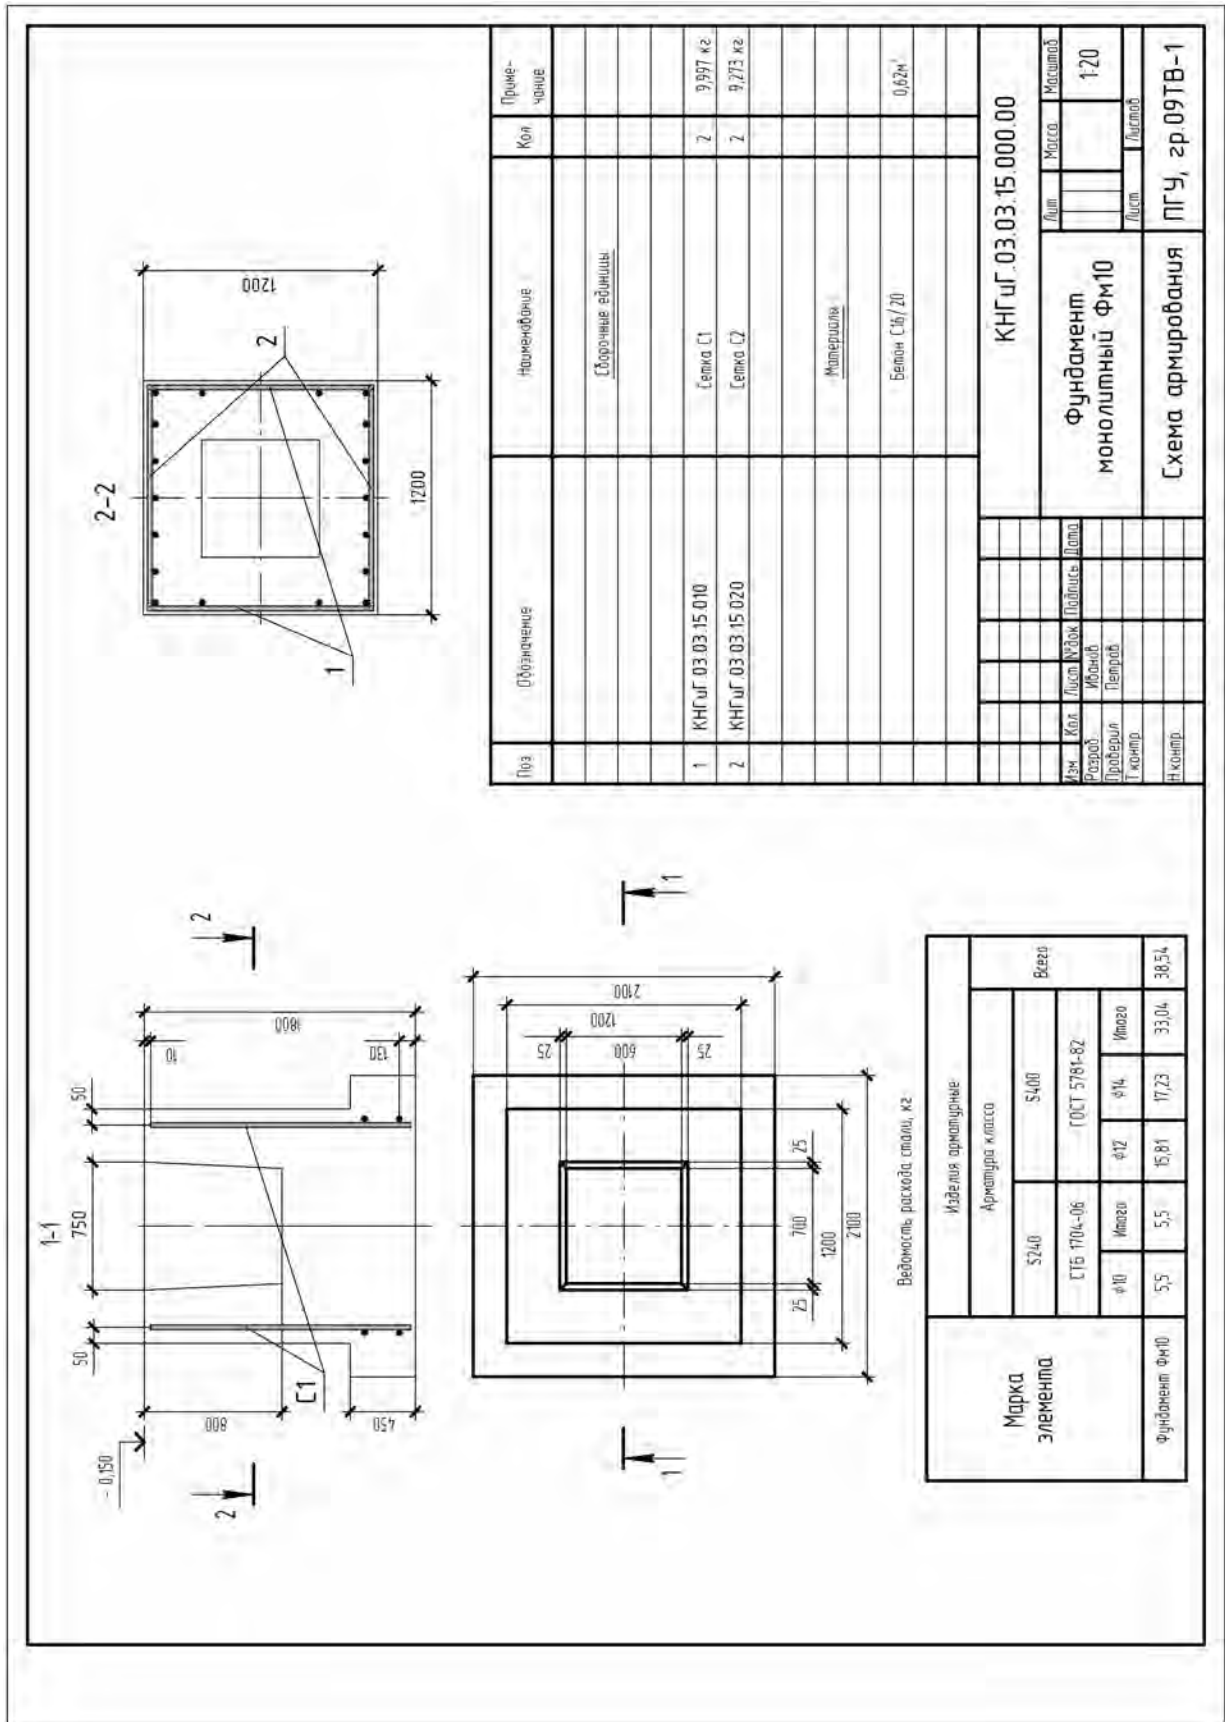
Сборочный чертеж фундамента ФМ10
